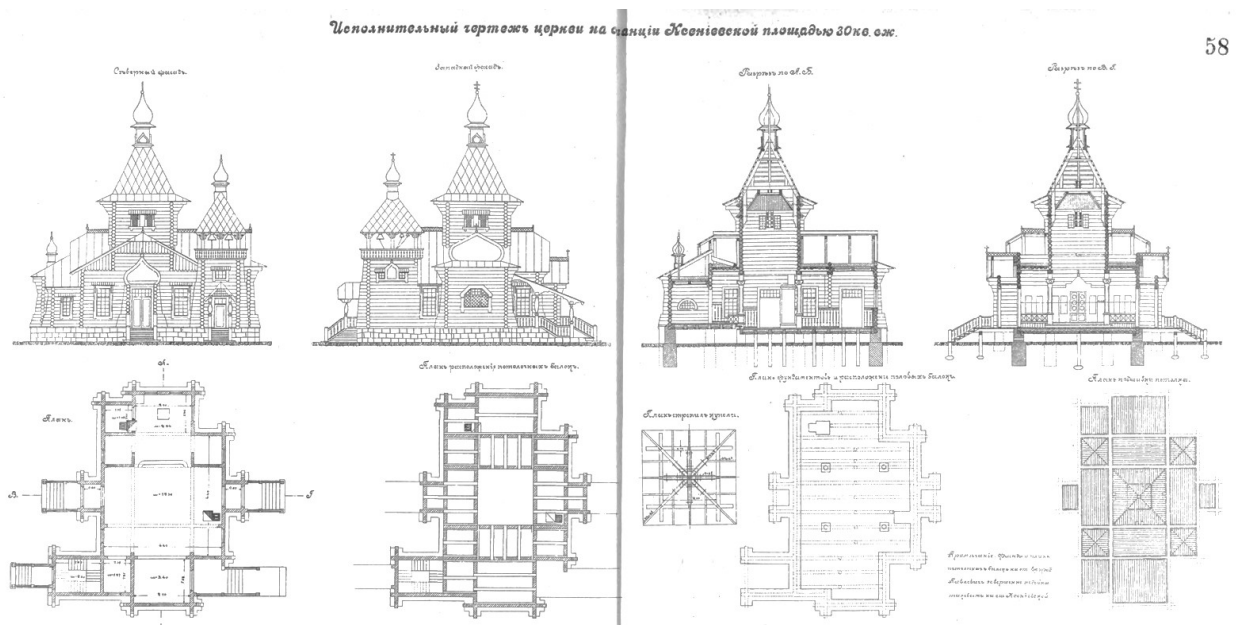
Исполнительный чертеж церкви на станции Ксеньевка (Альбом типовых и исполнительных чертежей постройки Западной части Амурской железной дороги)
